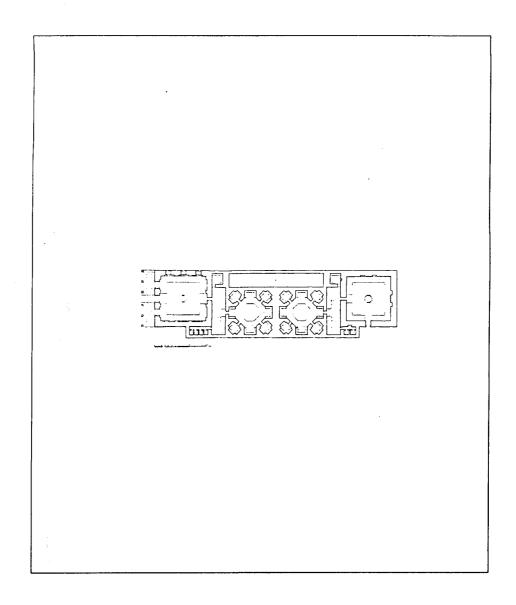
مسقط أفقي لعمارت وتربة يعقوب چلبي بازنيق (عن : إيفردى) .
